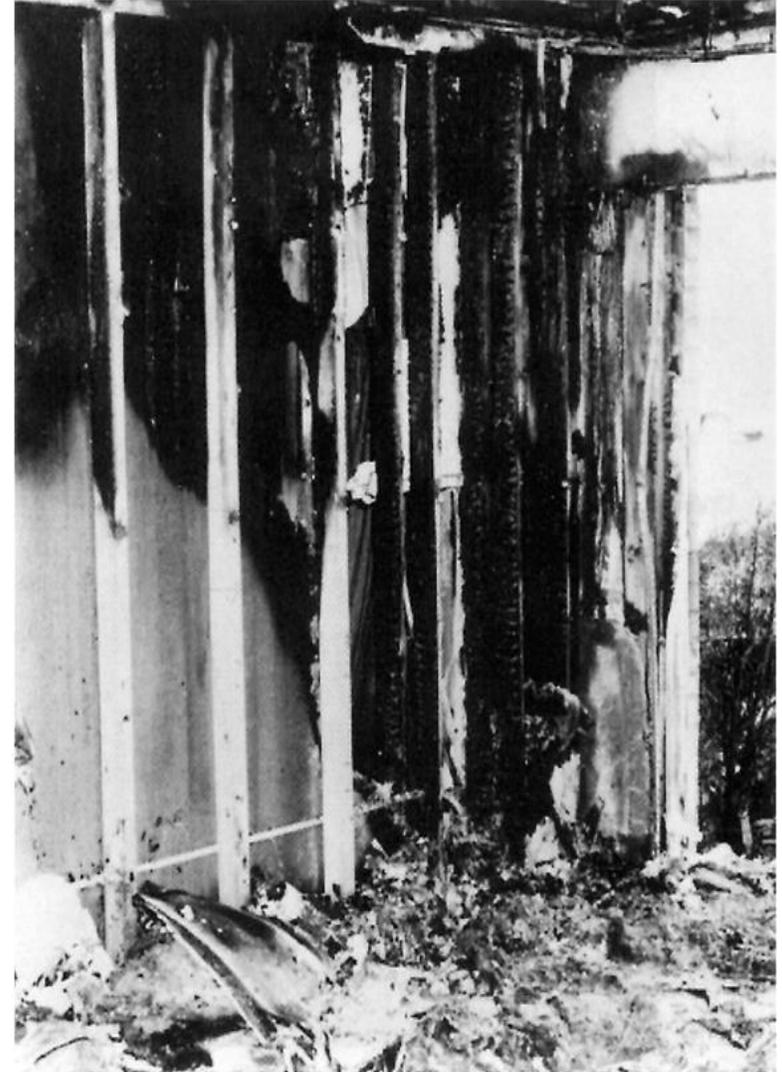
(b) Marca en V con Daños en Pared y en Vigas de Madera.
